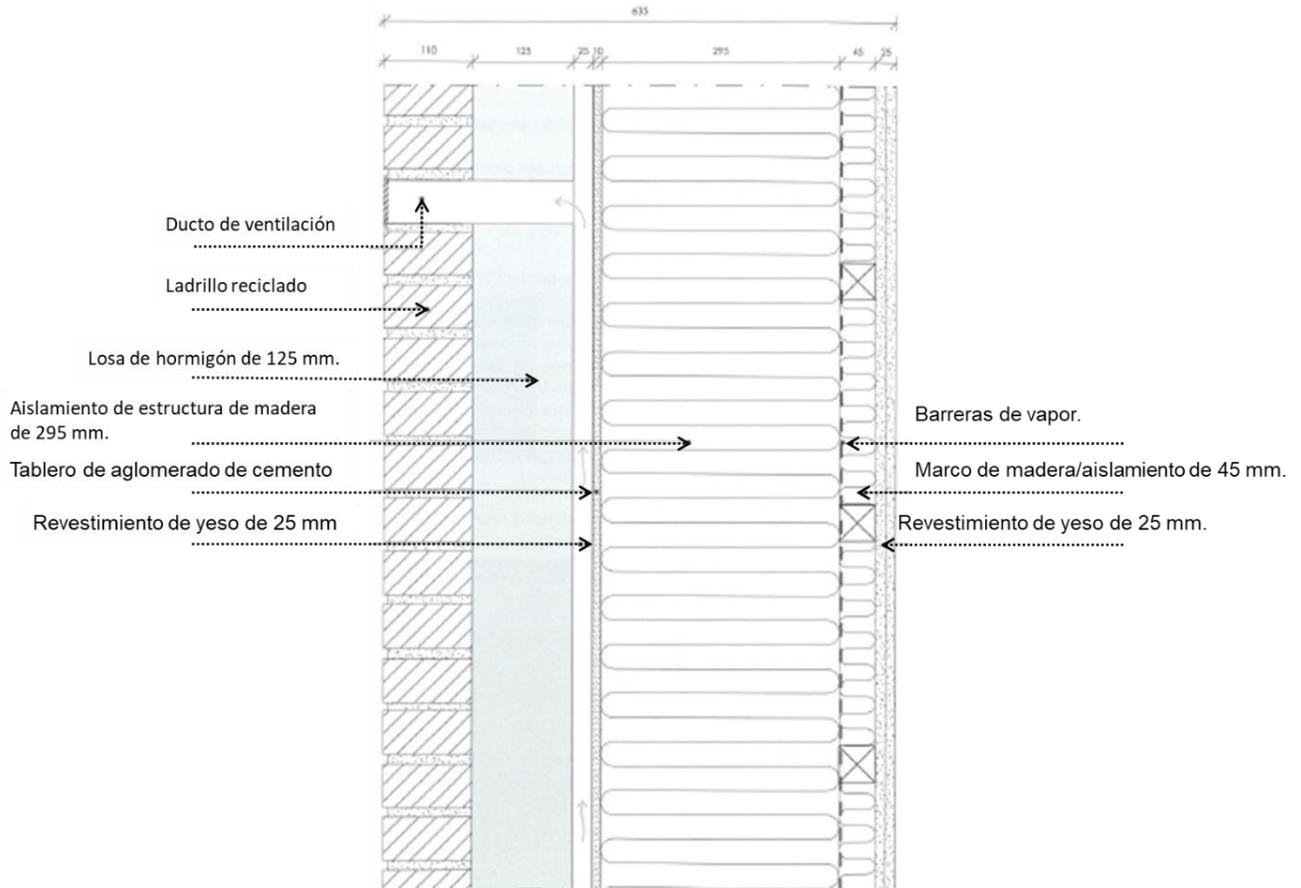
Detalle de muro en fachada (Lendager y Pedersen, 2020)
